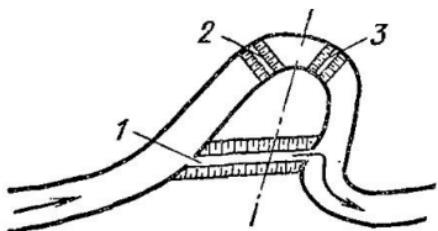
Устройство подземного перехода под защитой земляных перемычек
